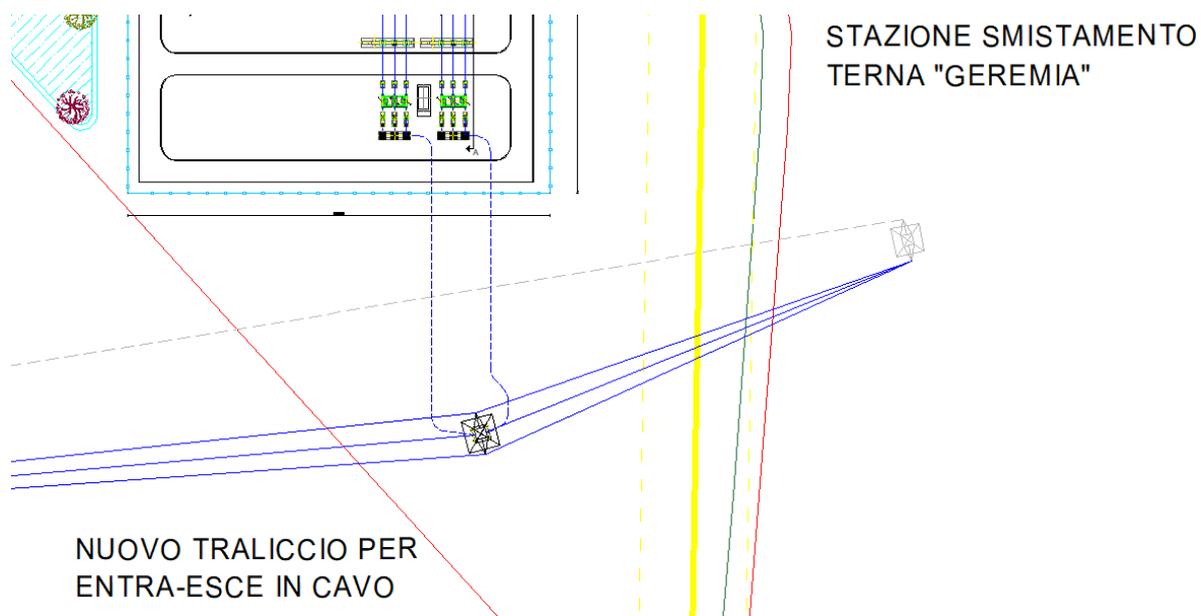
Layout del nuovo collegamento in entra esce della stazione TERNA
